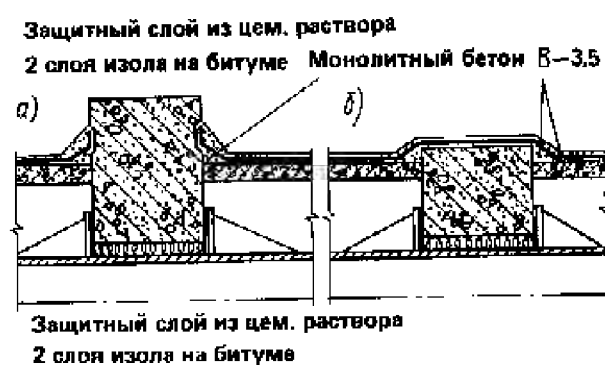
Гидроизоляция перекрытия канала у неподвижной опоры
